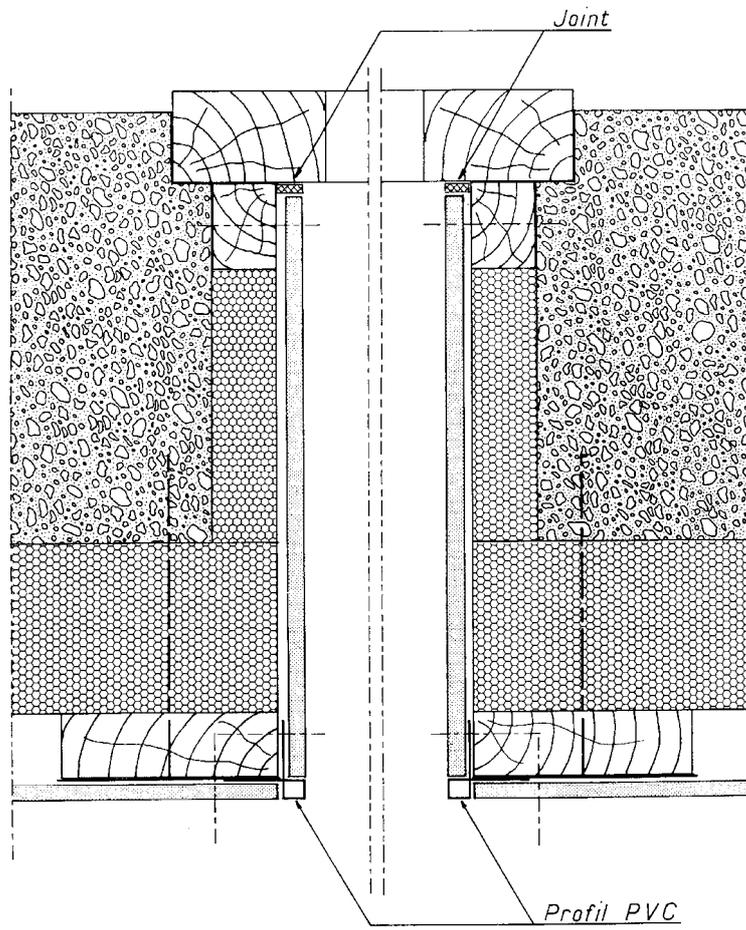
Encadrement de baie avec isolation complémentaire – Coupe horizontale - Pose en vêtage
